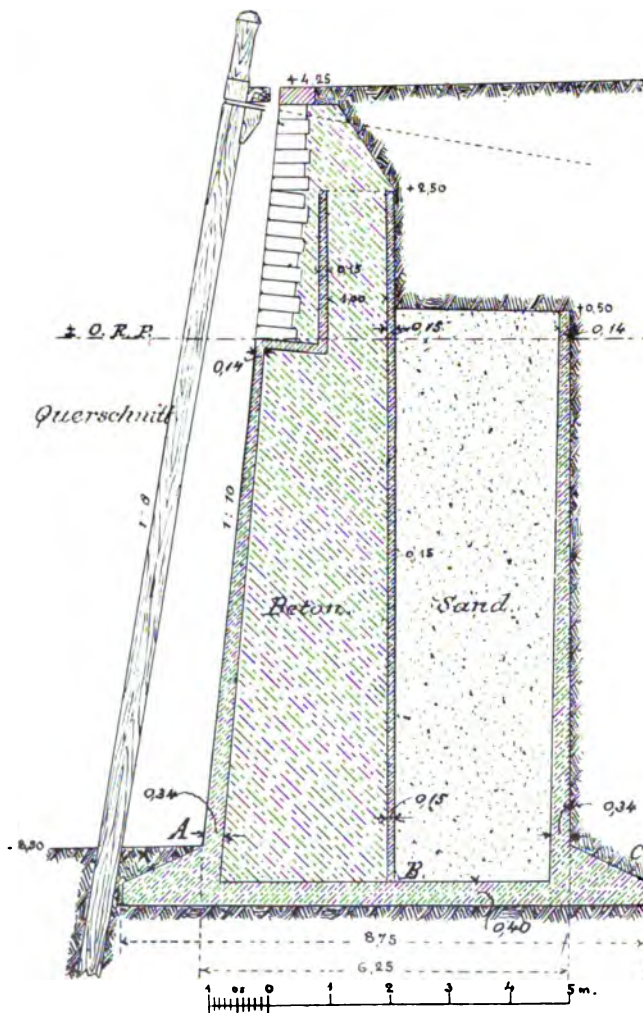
Entwurf einer Kaimauer in Rotterdam.
